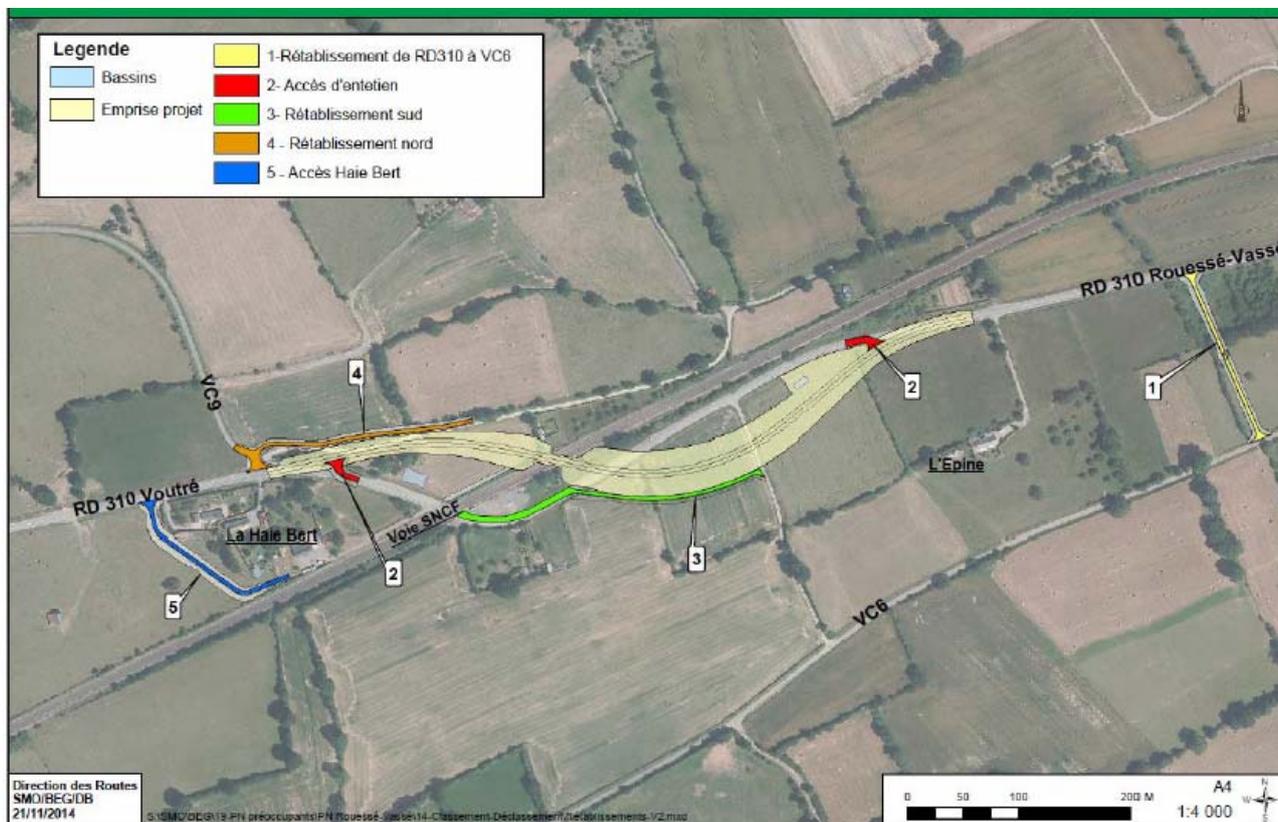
Plan général du projet. (Source : Etude d'impact)
